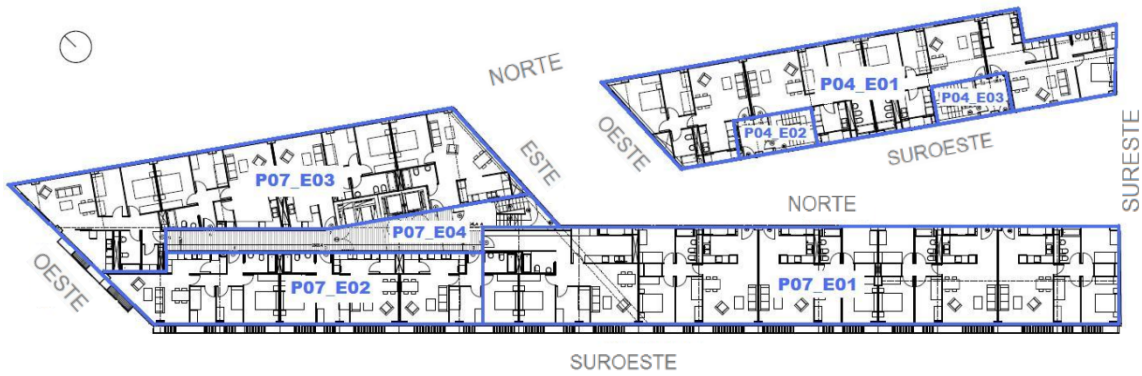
Espacios plantas tercera a quinta. Bloque de viviendas en el 22@.
